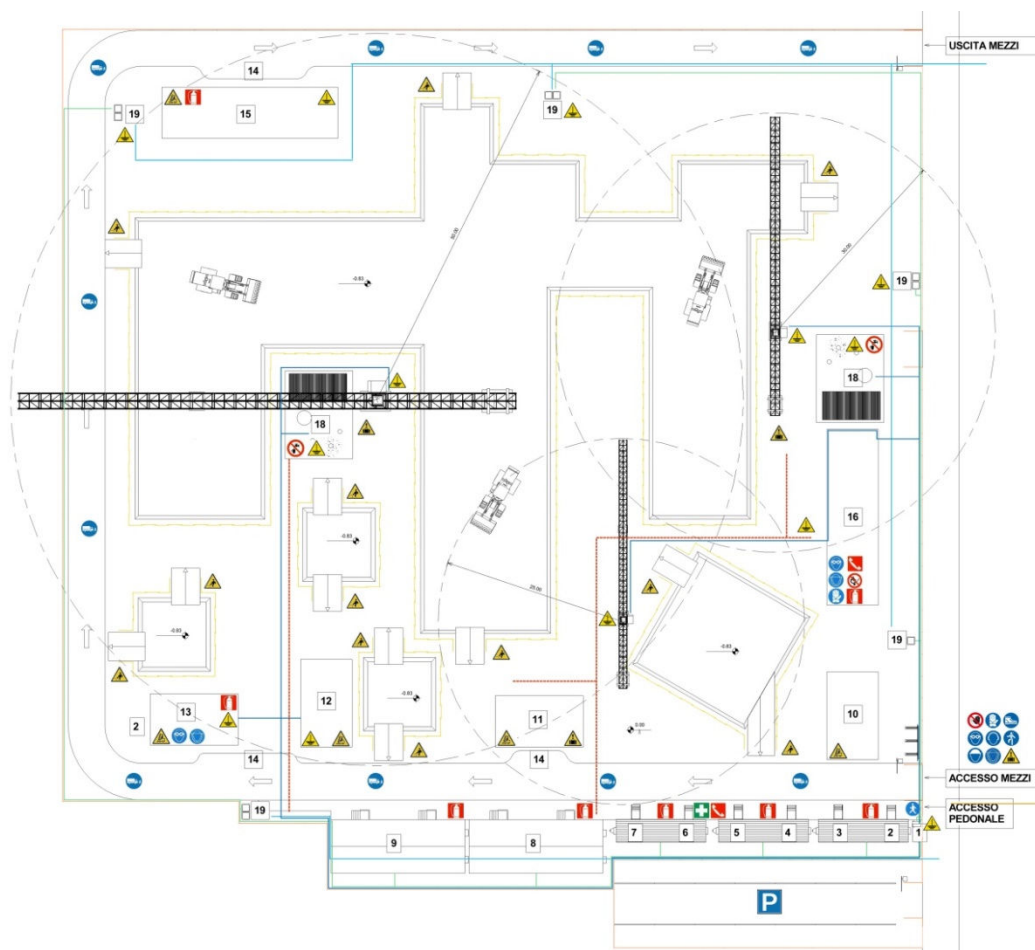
Layout fase di scavo: esempio di layout realizzato su Revit a partire da una vista in pianta del modello del cantiere all'interno della quale sono stati inseriti elementi di testo e simboli.
